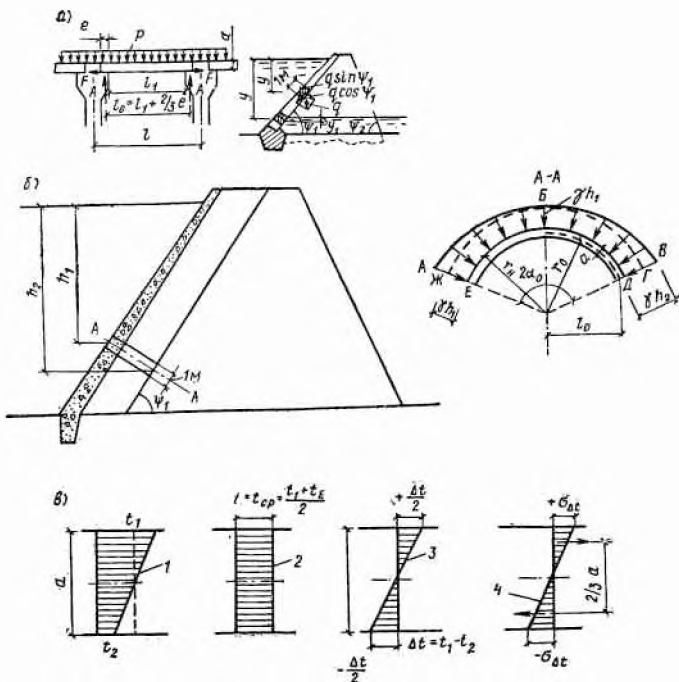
Схемы к элементарным расчетам напорных перекрытий
